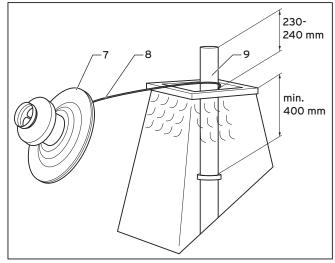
Монтаж насадки для шахты, арт. № 303 261
